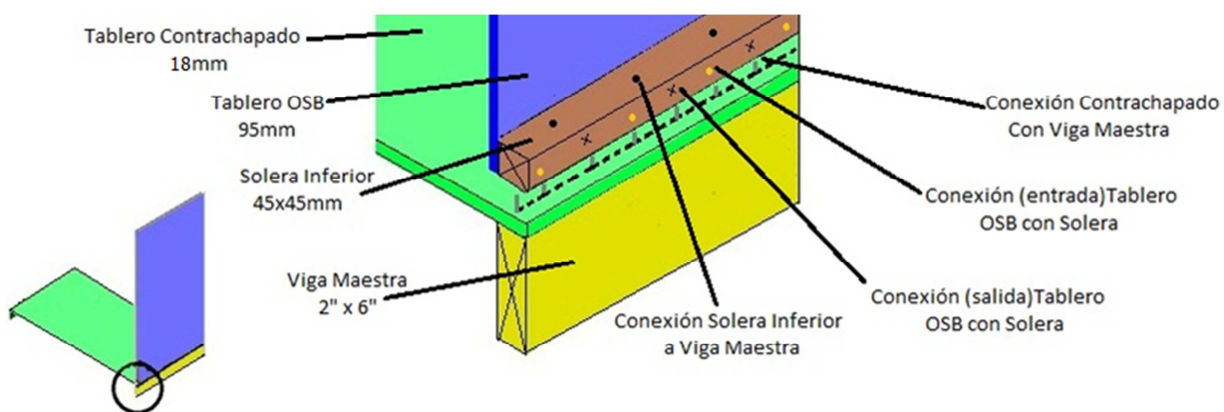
Detalle conexión entre el panel, viga y contrachapado
